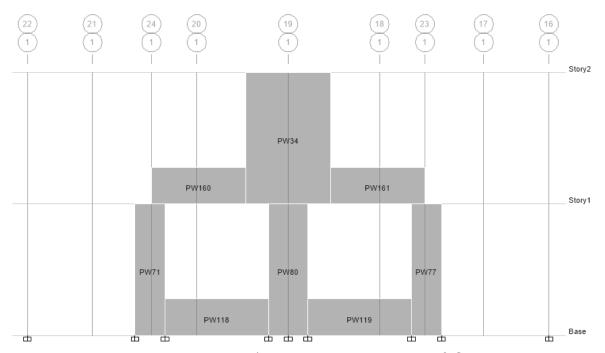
Distribución de muros de mampostería en planta alta N+2.52
